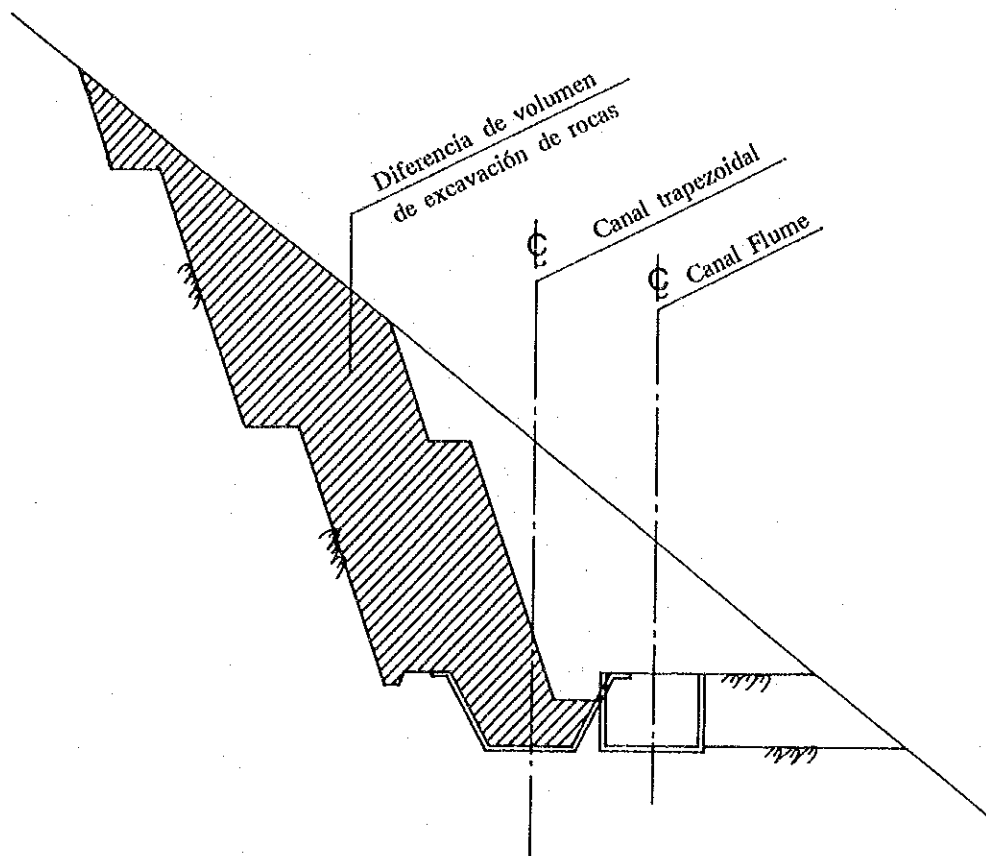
Comparación entre las Secciones de Forma Trapezoidal y Flume
